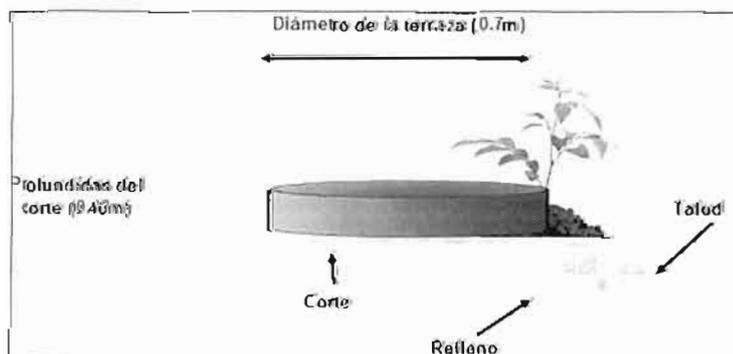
Esquema tipo del arreglo de terraza individual prevista para el proyecto
